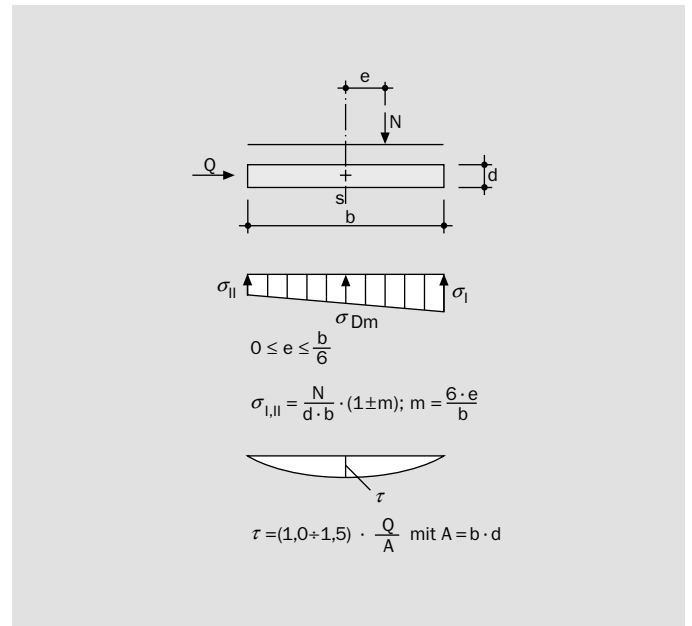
/1: Normal- und Schubspannungen für einen ungerissenen Querschnitt bei Scheibenbeanspruchung
